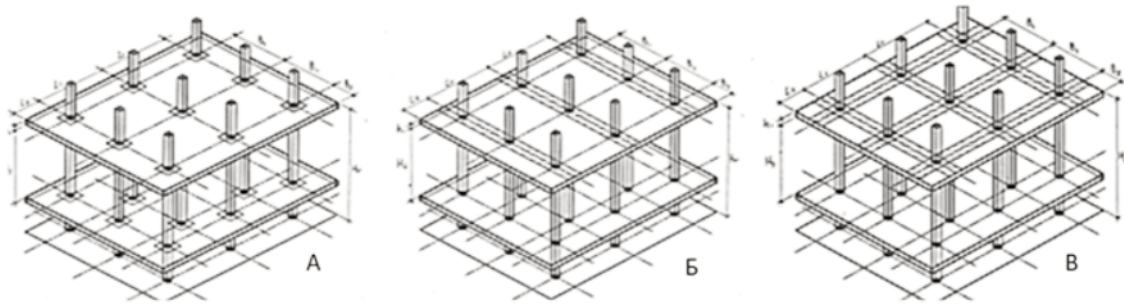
Схеми конструктивних рішень плоских монолітних плит перекриття: А – без балок з армуванням зон продавлення; Б – з балками в одному напрямку; В – з балками в двох напрямках
